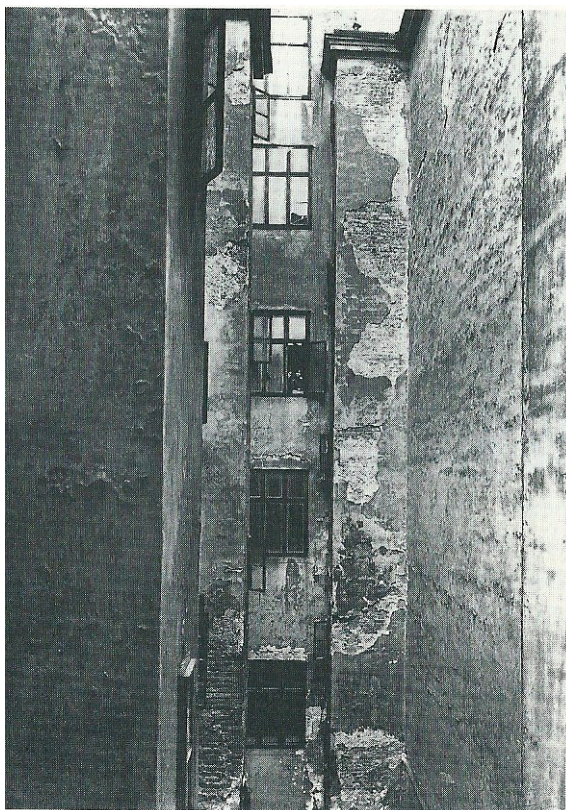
Enger Lichtschacht eines Hauses in der Stuwertstrasse, 1020 Wien.
